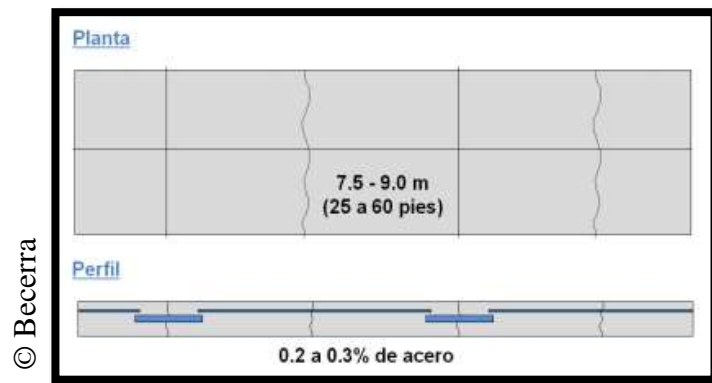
Pavimento de concreto armado con juntas y barras transversales
